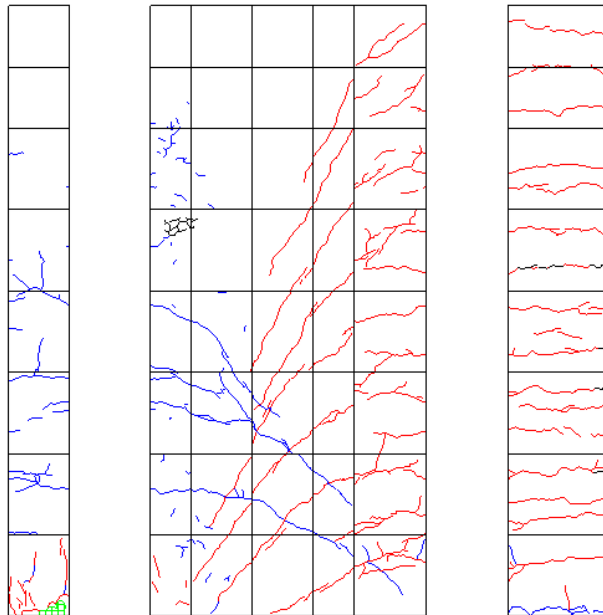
R=-1/50 ひび割れ図
